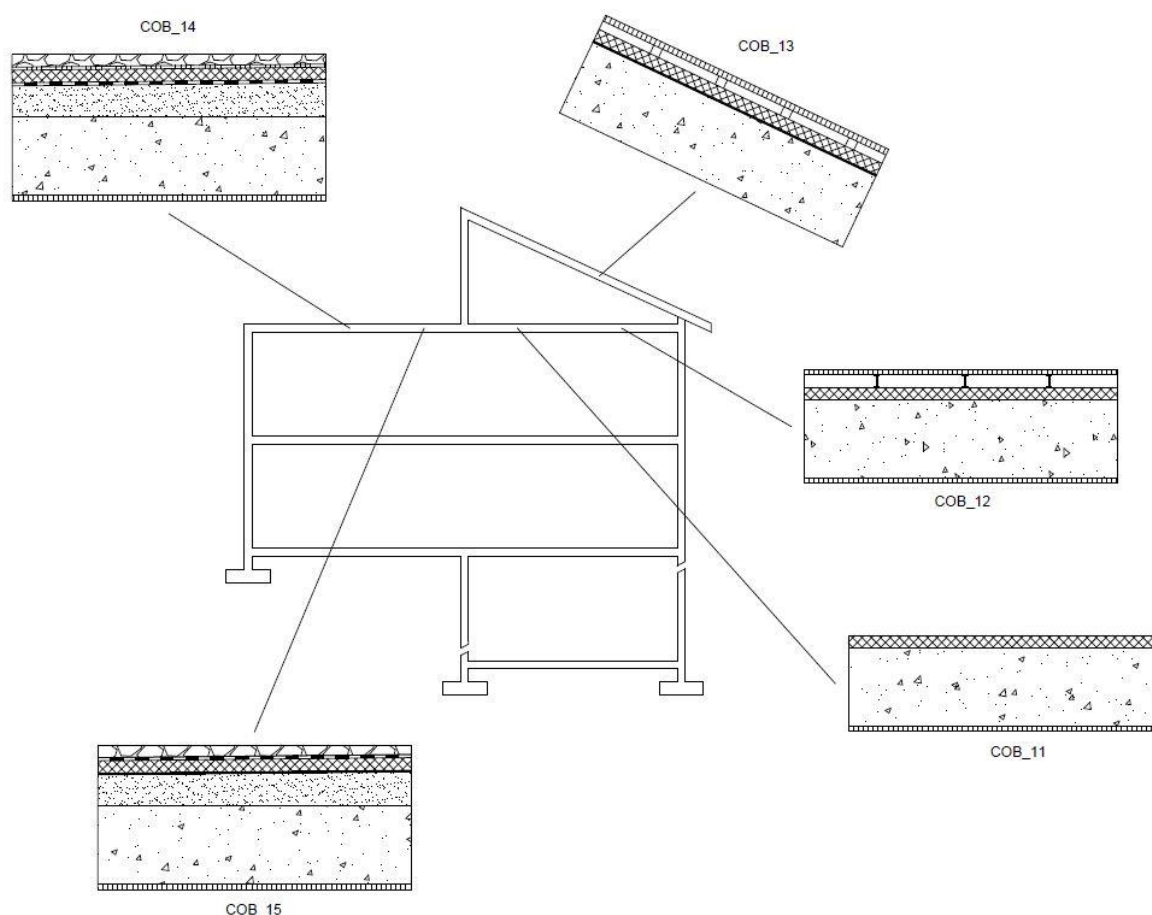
Soluções correntes de coberturas em edifícios com estrutura porticada de betão armado
